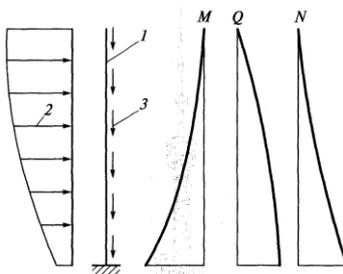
Усилия в стволе башни (расчетная схема и эпюры): 1 – ствол башни; 2 – ветровая нагрузка; 3 – вертикальная нагрузка
